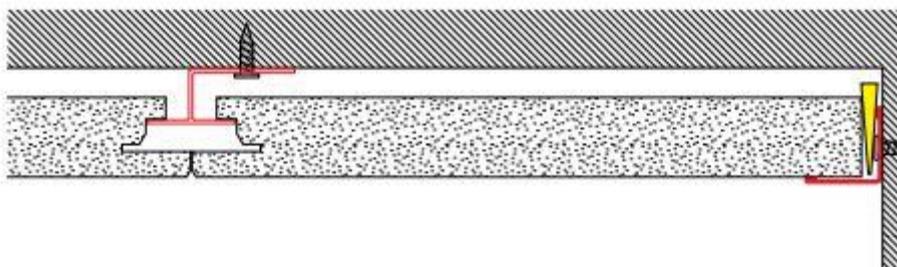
Sistema fijado directamente al forjado. Detalle de encuentro entre paneles y encuentro con la pared. Se trata del sistema tipo Facett y del canto tipo G (fuente: rockfon.es)
